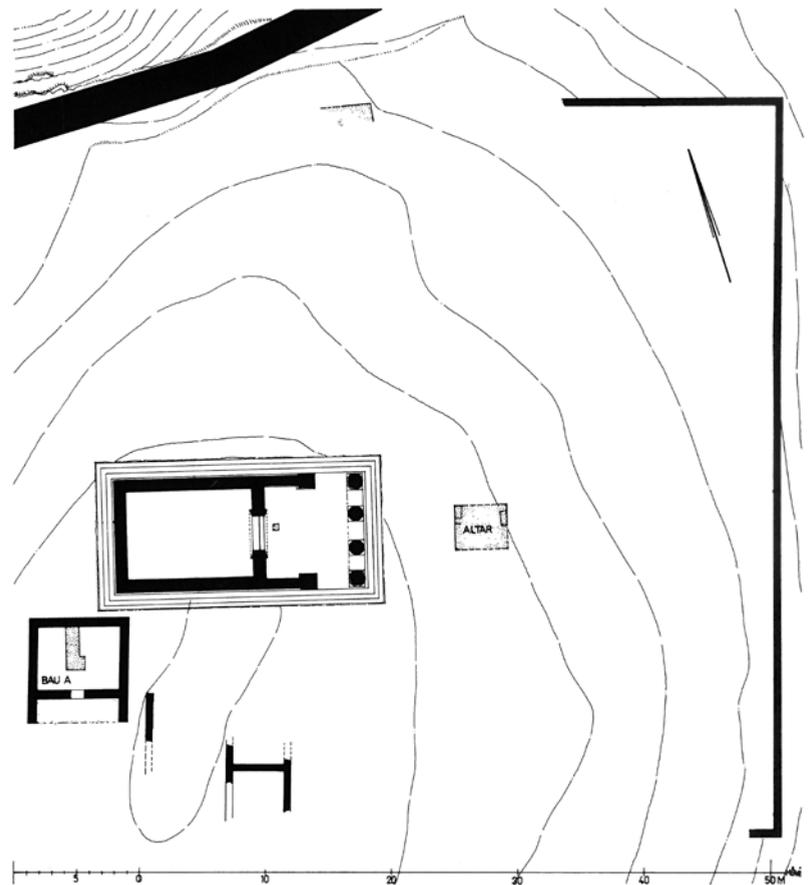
Milet, Humeitepe. Plan vom Nordplateau mit den rekonstruierten Grundrissen (M. 1 : 60)
